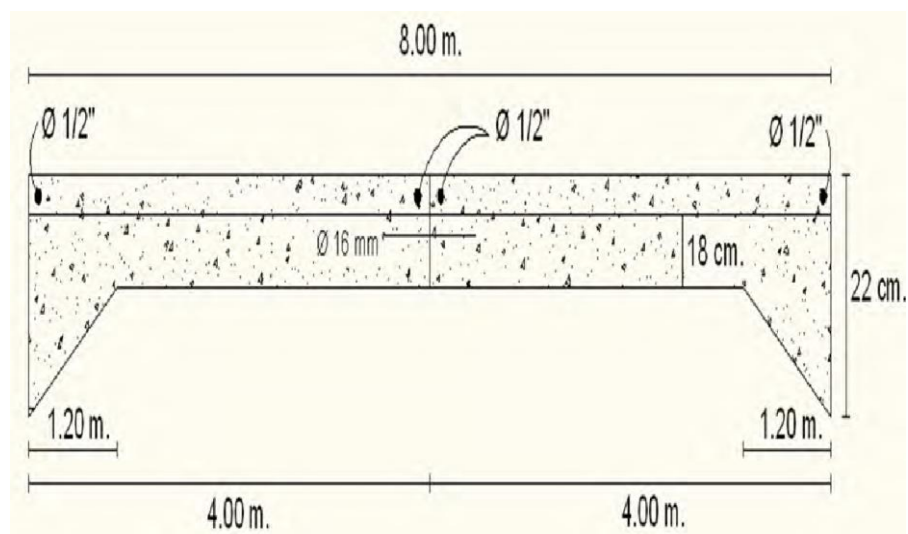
Sección del pavimento en la Avenida Venezuela 1924.
